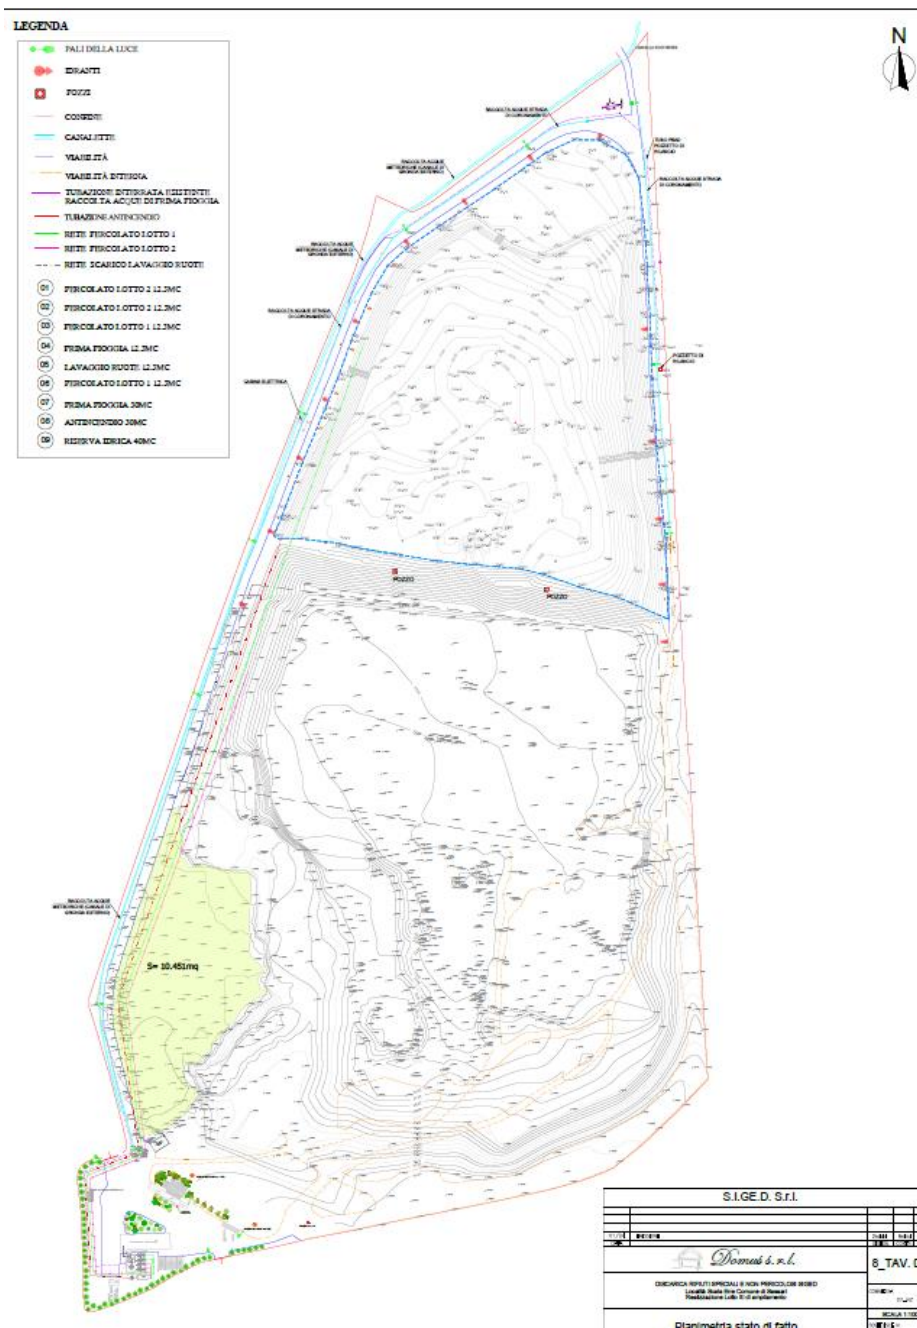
Estratto Tavola 8 TAV 01S Planimetria Stato di fatto
